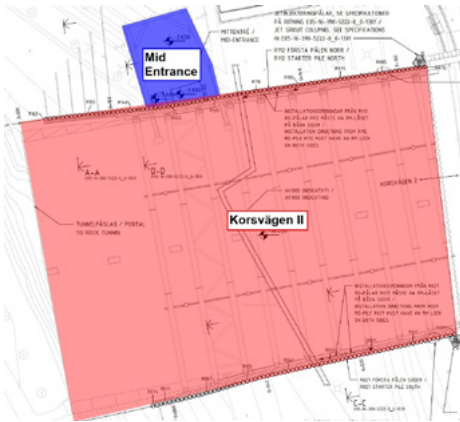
RD-Pfahlwand Korsvågen – Grundriss
